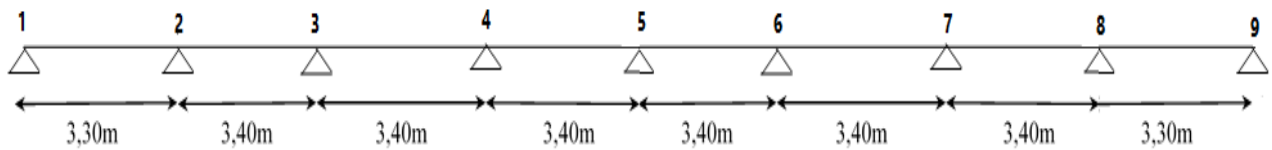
Schéma statique de la poutrelle à huit travées
